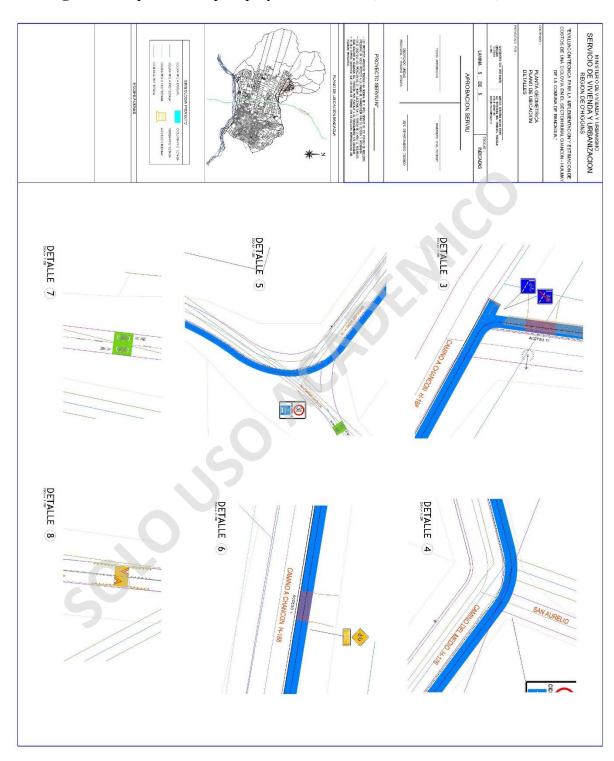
planimetría para proyecto SERVIU. (Detalle encuentros)
